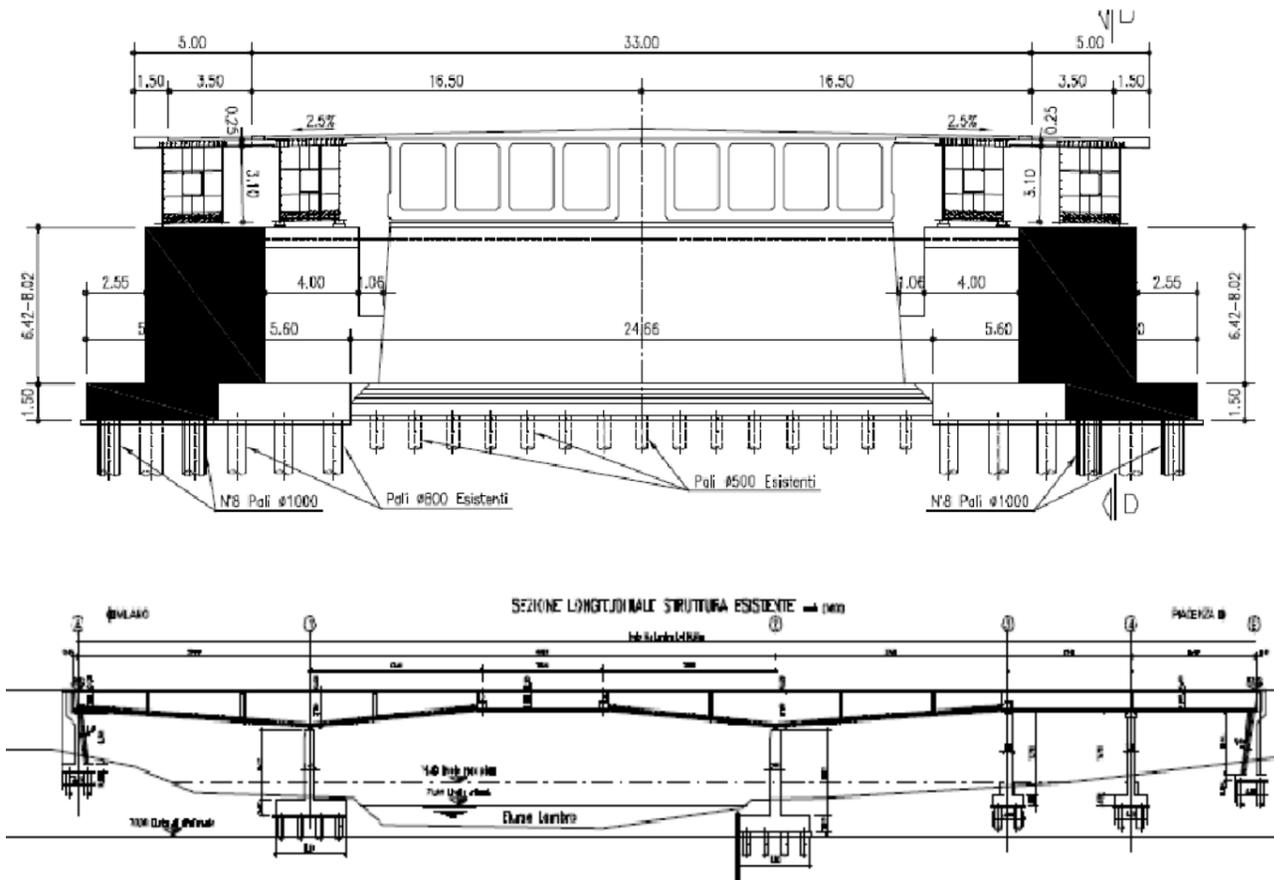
Ponte sul Lambro – Sezione trasversale e longitudinale
